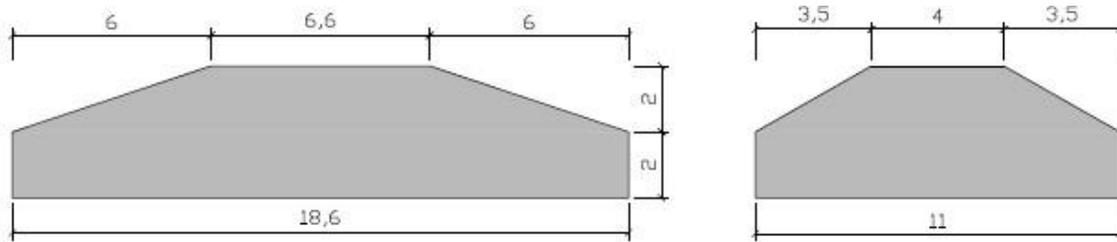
Vista transversal y longitudinal de las zapatas del Puente 2.
